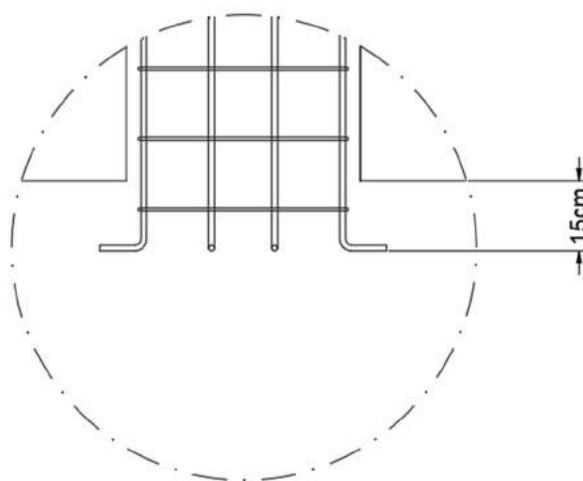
Detalhamento dos pilares da edificação segundo projeto original.
